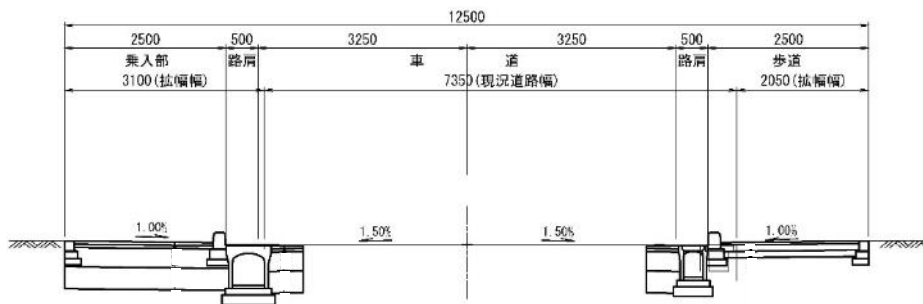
(6) 標準断面図 (主要地方道行田・蓮田線 (拡幅部) 幅員 12.5m)
